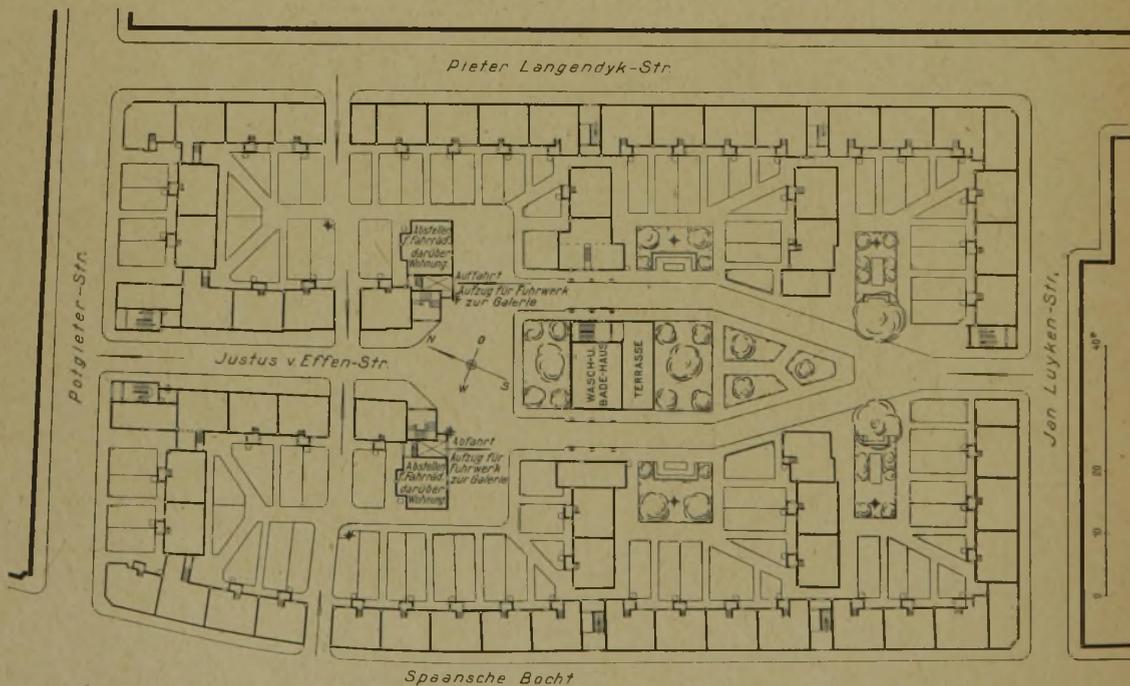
Erdgeschoßgrundriß der Gesamtanlage. (1 : 1200.)
